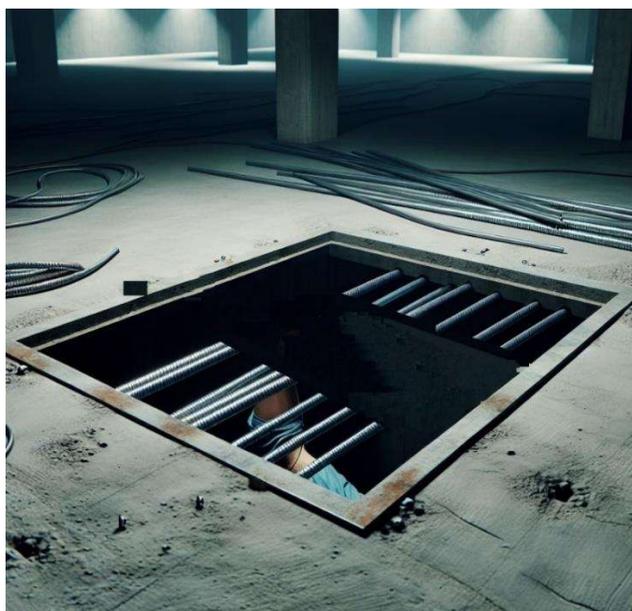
OpenAI. (2025). Colocación de armado de viga a muro y losa, imagen generada por IA.
